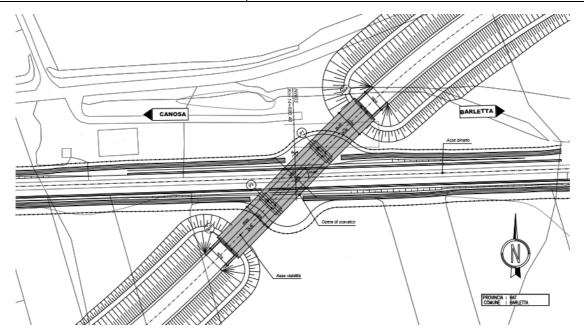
Cavalcaferrovia NW03 – Planimetria
